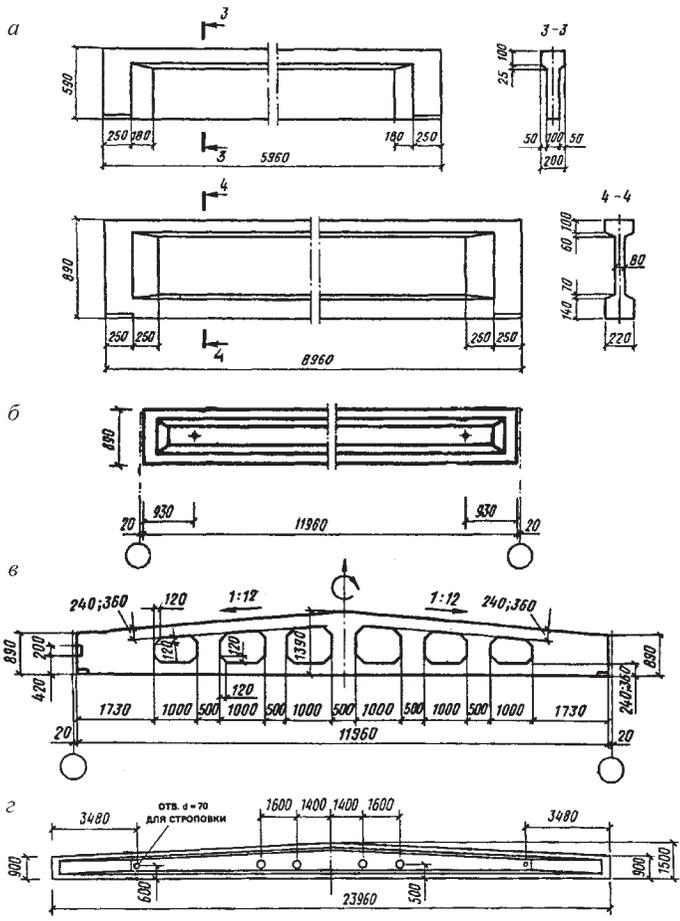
Железобетонные балки: а – для покрытий с плоской кровлей пролетом 6 и 9 м; б – с параллельными поясами для покрытий с плоской и скатной кровлей пролетом 12 м; в – решетчатые пролетом 12 м; з – двутавровые пролетом 24 м
